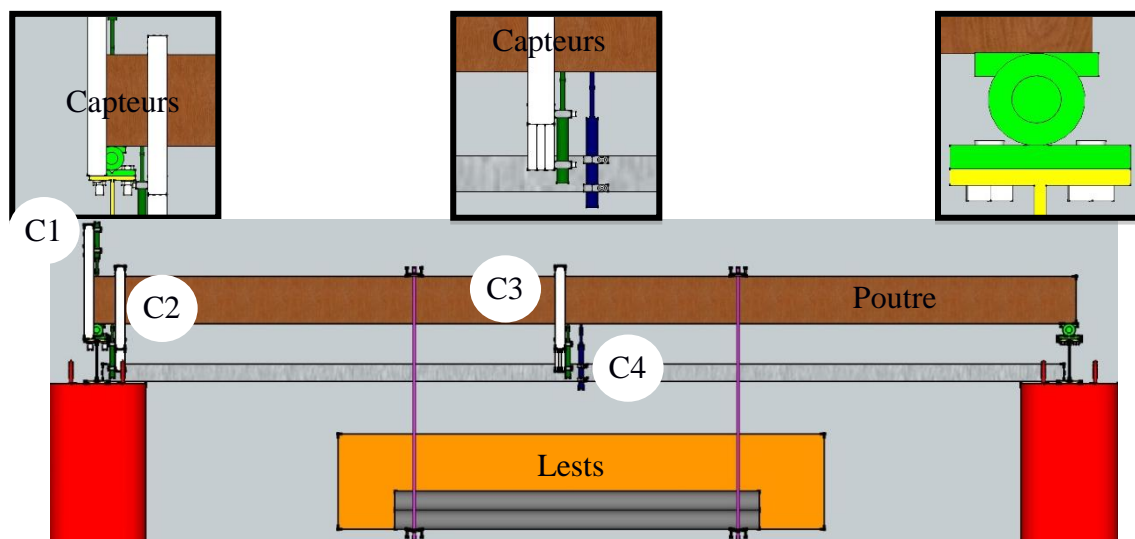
Schéma de détails d'une poutre montée sur le montage banc d'essai
